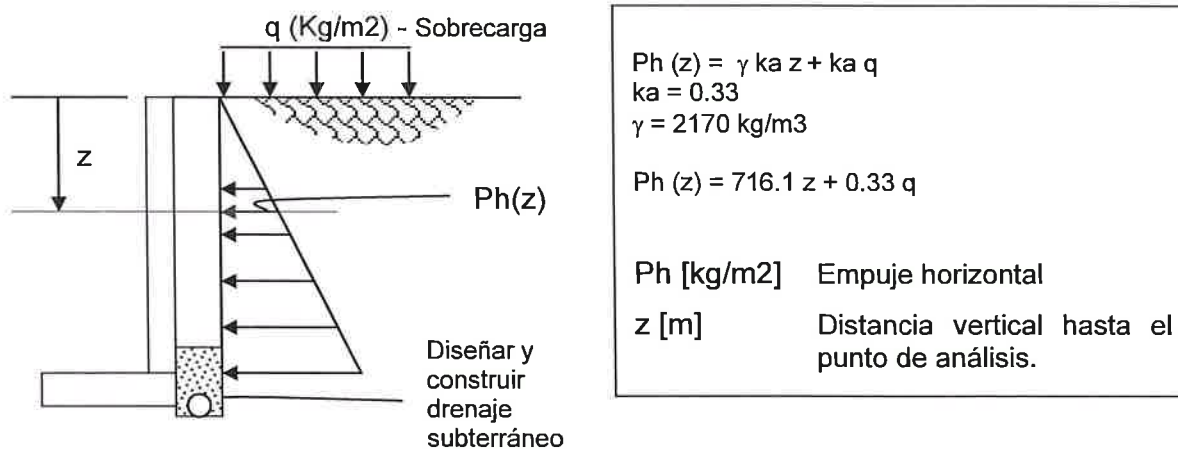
Esquema de Empujes Activos para Diseño de Muro.
